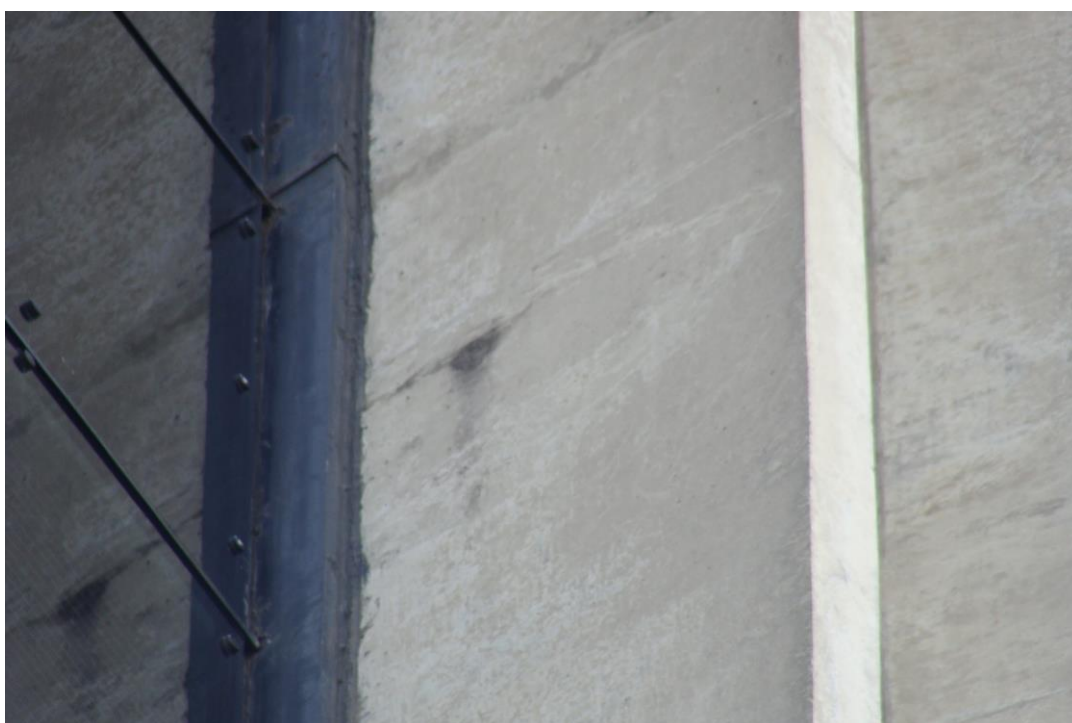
Armadura exposta pilar P14 (4º pavimento) (19/11/2013)
